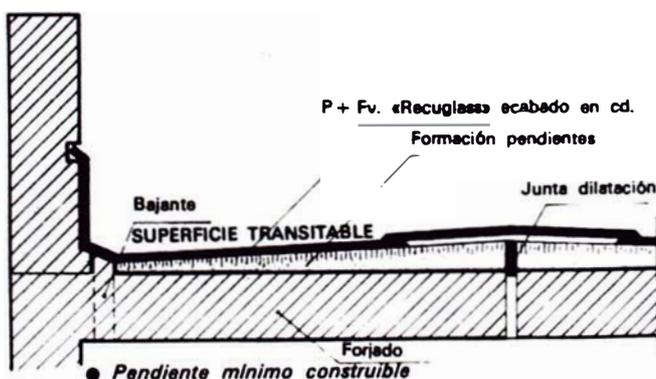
Detalle de la aplicación de poliéster y fibra de vidrio proyectados "en situ" en un tejado.
